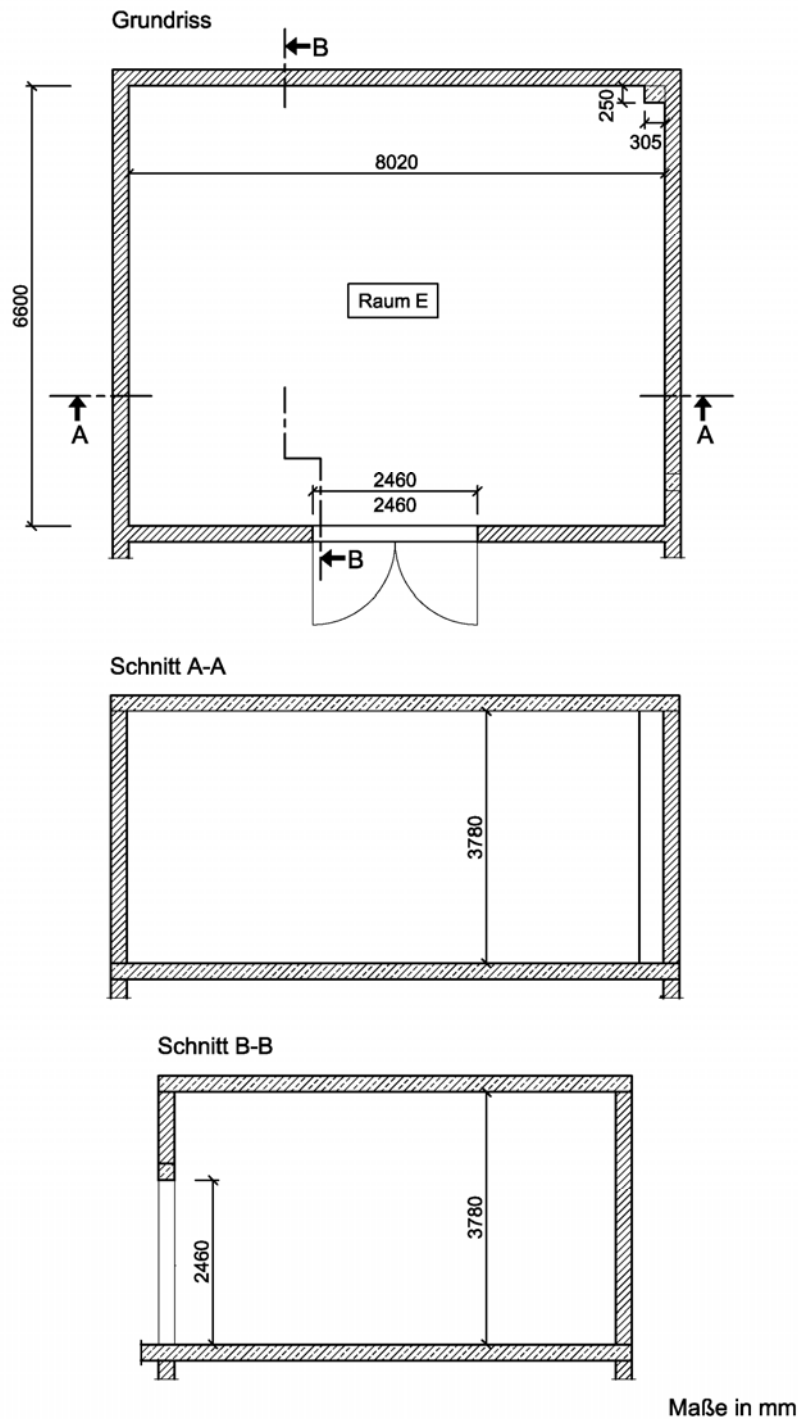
Grundriss und Schnitte des Hallraums.
